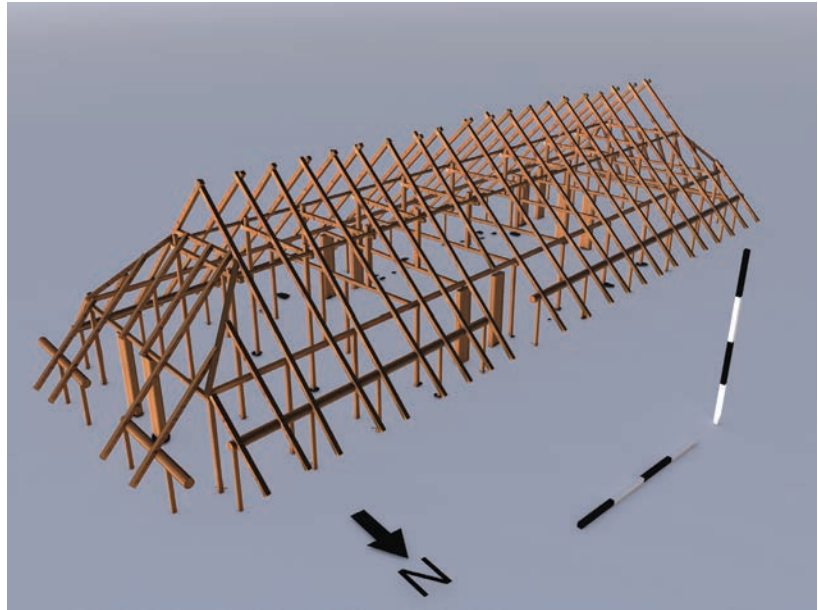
Driedimensionale reconstructie van het houtskelet van woonstalhuis STR 3, gemaakt door Leander Pierik voor zijn afstudeeronderzoek van Saxion Hogeschool).
